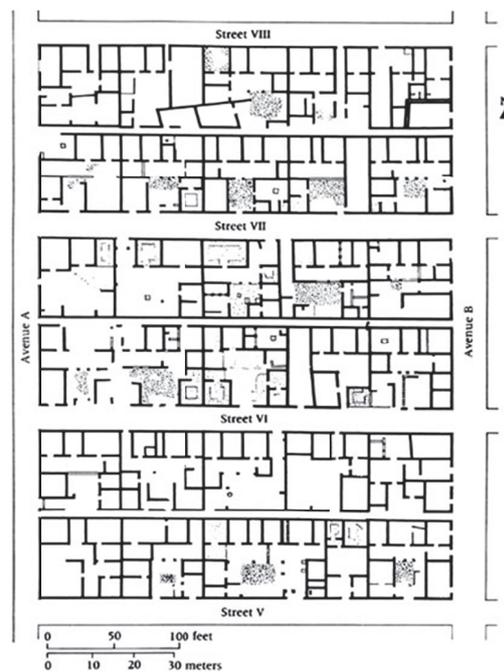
Detalle del trazado de las viviendas de Olinto.
